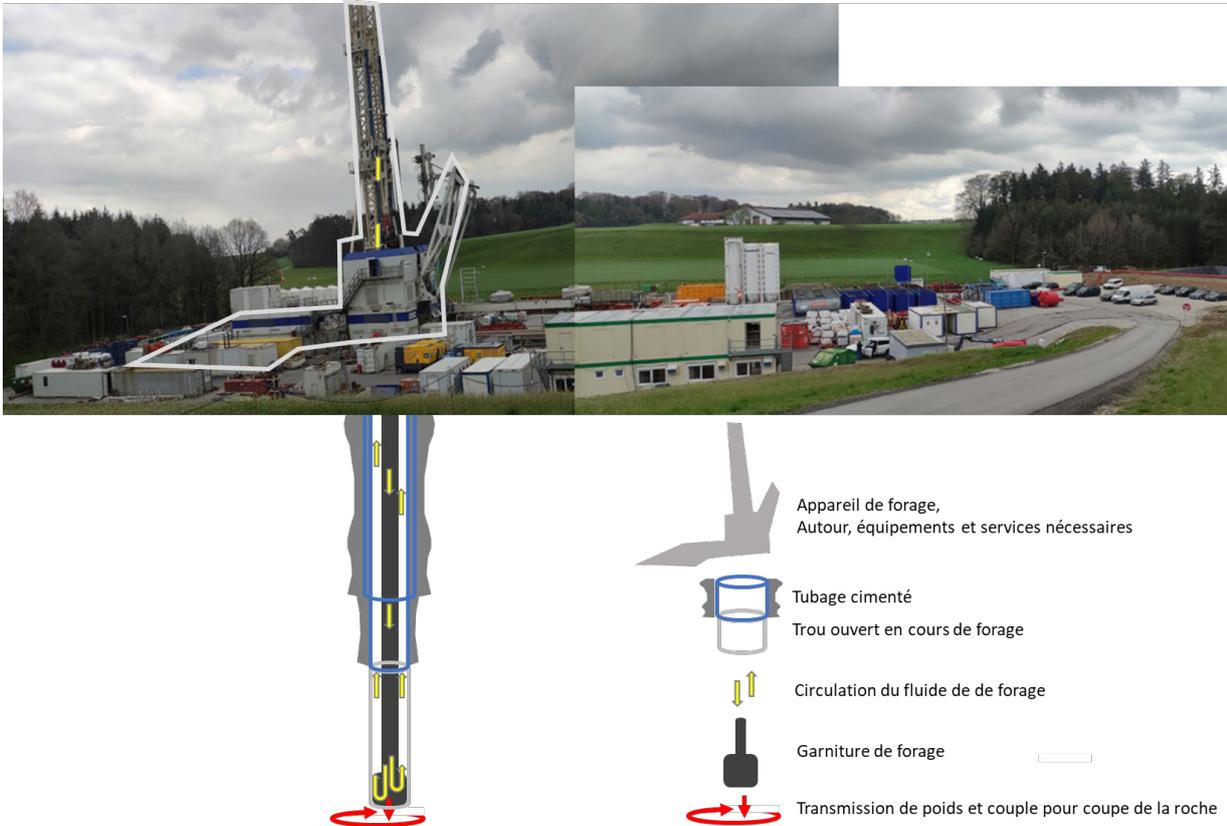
Appareil de forage de type géothermie sur chantier (Source : photo d'un chantier de DeutscheErdwärme prise par Lithium de France lors d'une visite de site en 2023)
